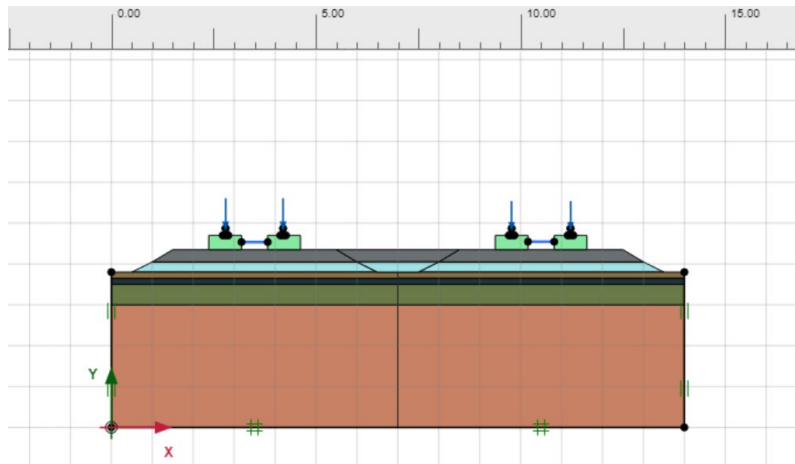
Modèle géométrique de la double voie pour la plateforme 2
